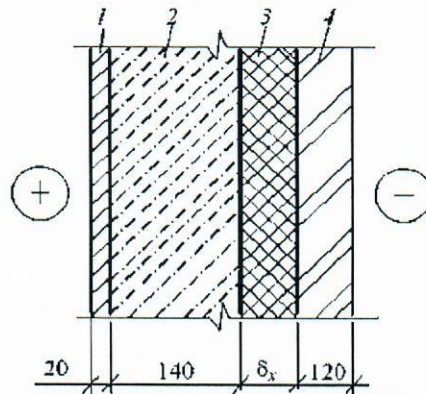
Вариант 2-й конструкции наружной стены:
